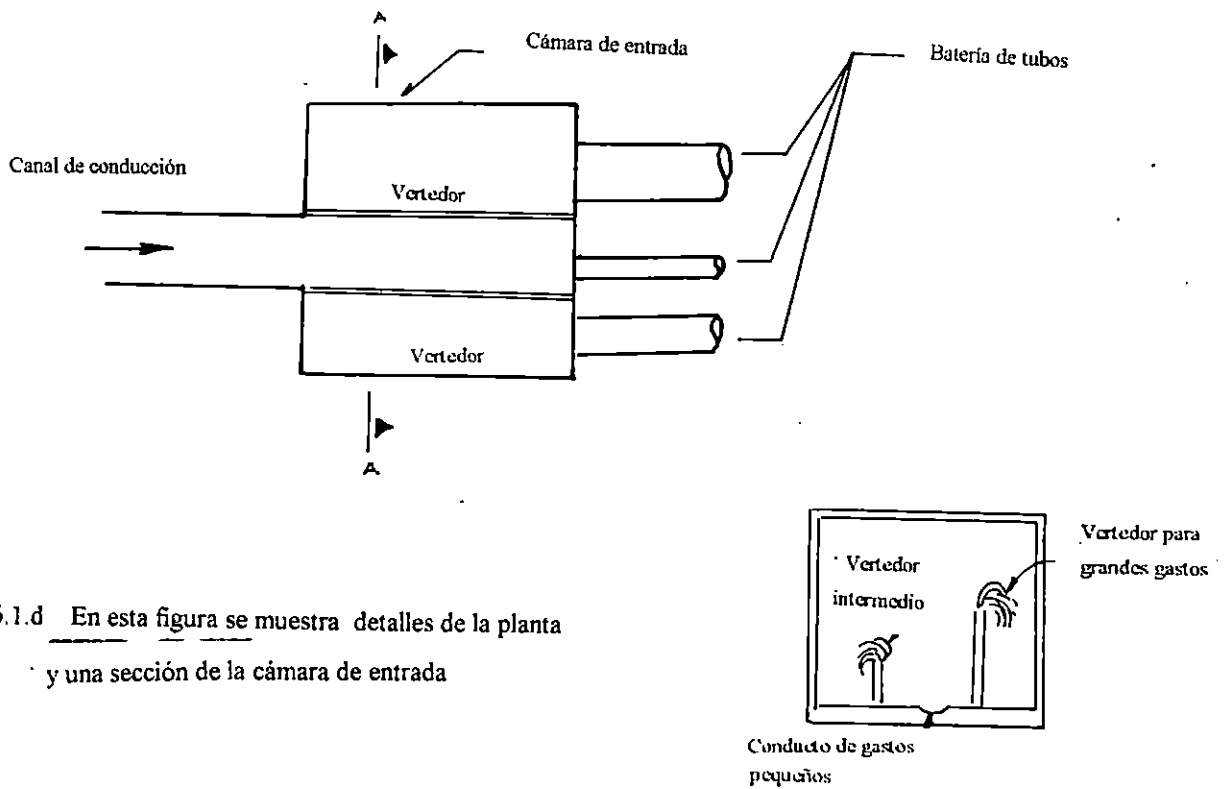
d En esta figura se muestra detalles de la planta y una sección de la cámara de entrada
